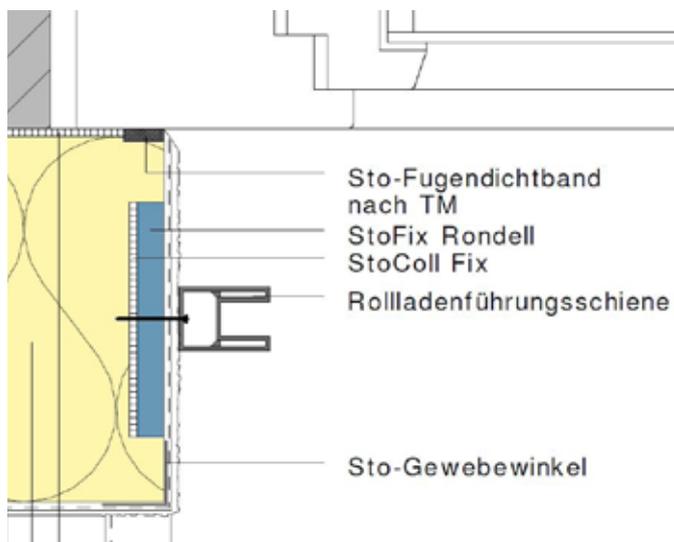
Führungsschienenmontage mit Montageelement Quelle: Sto
